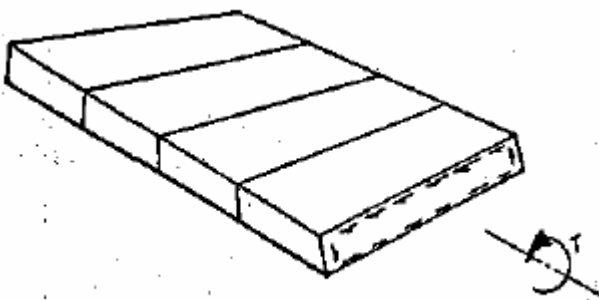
Torção em uma laje como se fosse viga, HAMBLY (1976)
